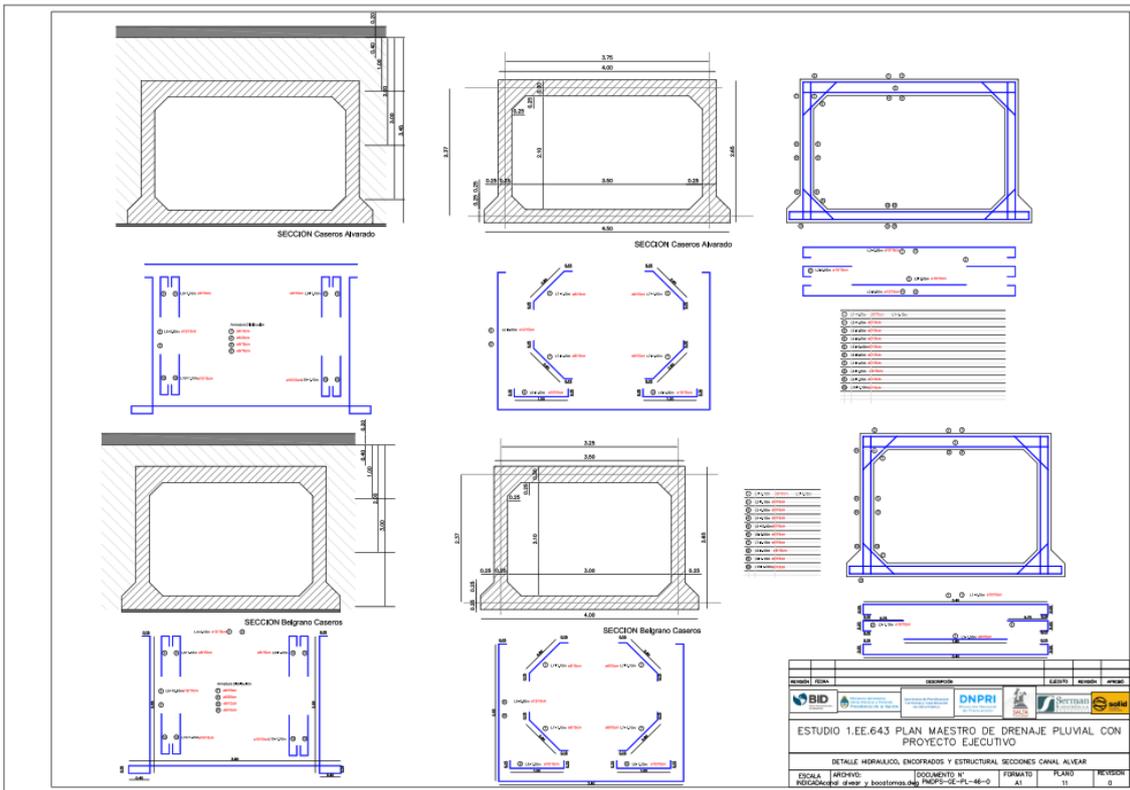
Plan Maestro de drenaje Pluvial – Canal Alvear
